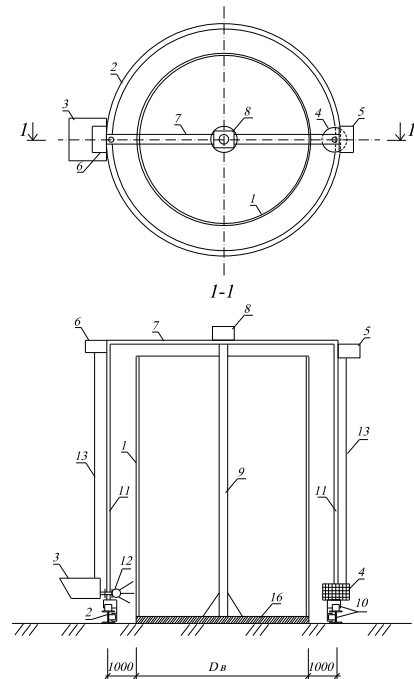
Монтаж опалубочной системы: 1- внутренняя опалубка резервуара; 2- роликовые пути; 3- торкрет-установка; 4- бухта арматурной сетки; 5- механизм подъема бухты; 6- механизм подъема торкрет-установки; 7- портал; 8- механизм вращения портала; 9- центрирующая стойка; 10- горизонтальный и вертикальный ролики; 11- стойка портала; 12- сопло торкрет-установки; 13- гибкие тяги; 16- днище резервуара;  $D_{в}$ - внутренний диаметр резервуара
